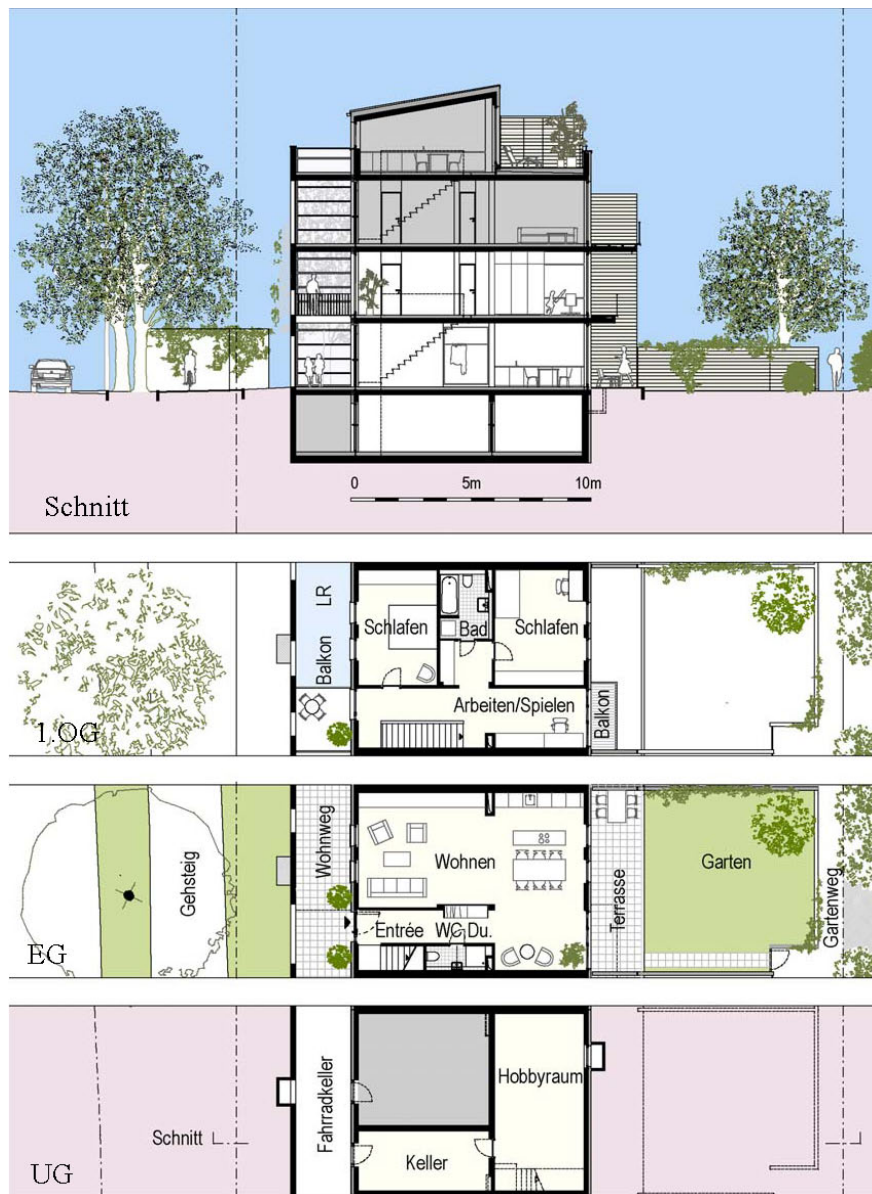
Grundtyp der Garten-Maisonette, Schnitt und Grundriss (antes...Immobilien GmbH)
